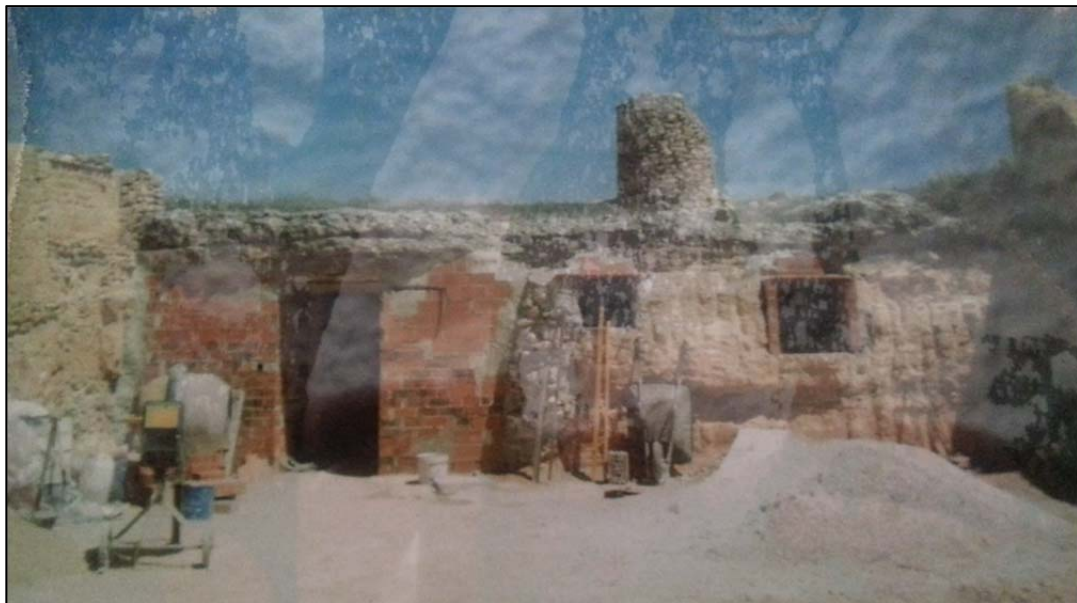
Proceso de construcción de la fachada. Casa-cueva nº3
